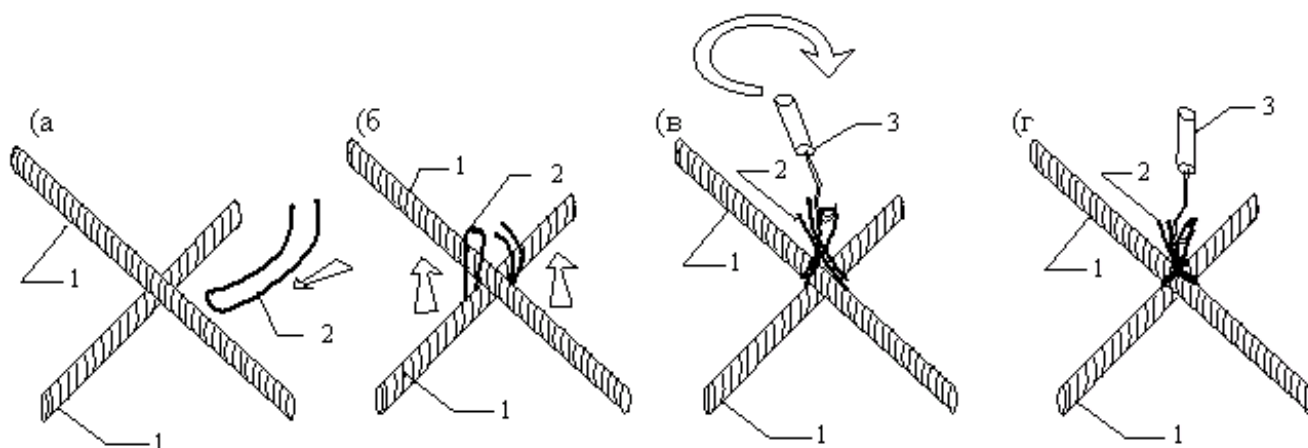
Схема фиксации арматурных стержней вязальной проволокой: а) подергивание проволоки под узлом; б) выравнивание концов проволоки; в) скручивание концов проволоки вязальным крюком; г) зафиксированный узел: 1 – арматурный стержень; 2 – вязальная проволока; 3 – вязальный крюк
